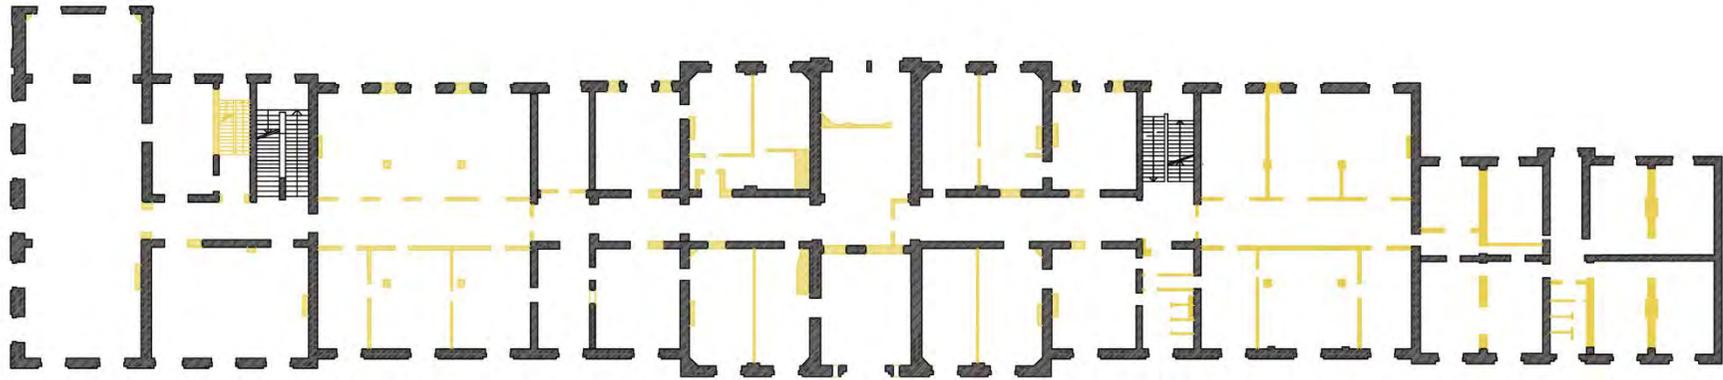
Plans du rez-de-chaussée inférieur existant-projeté. Échelle 1/500
